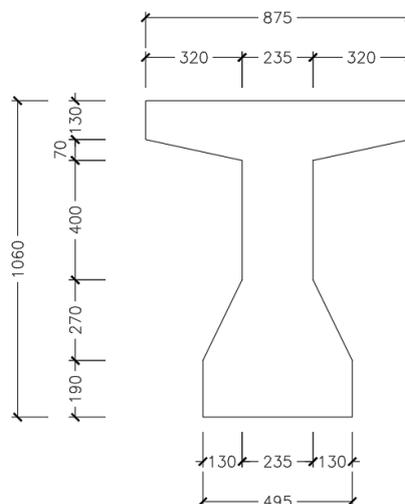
Sección transversal de la viga postensada. Dimensiones en milímetros.
